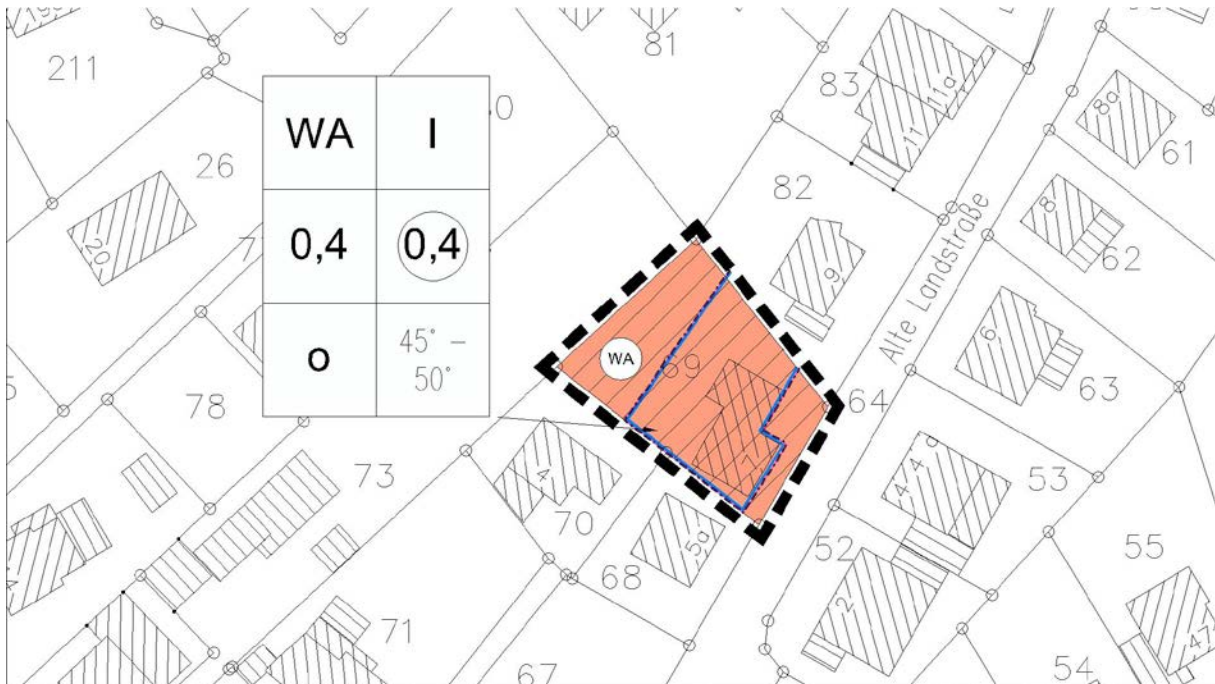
Geplanter Bebauungsplan Nr. 3, 28. Änderung, ohne Maßstab
